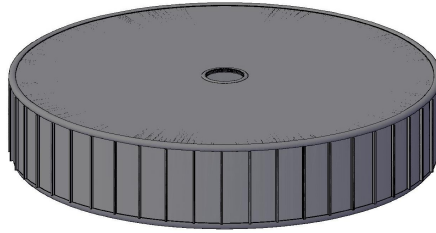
Зовнішній вигляд конструктивної схеми циліндричного резервуару об'ємом 140000 м³
